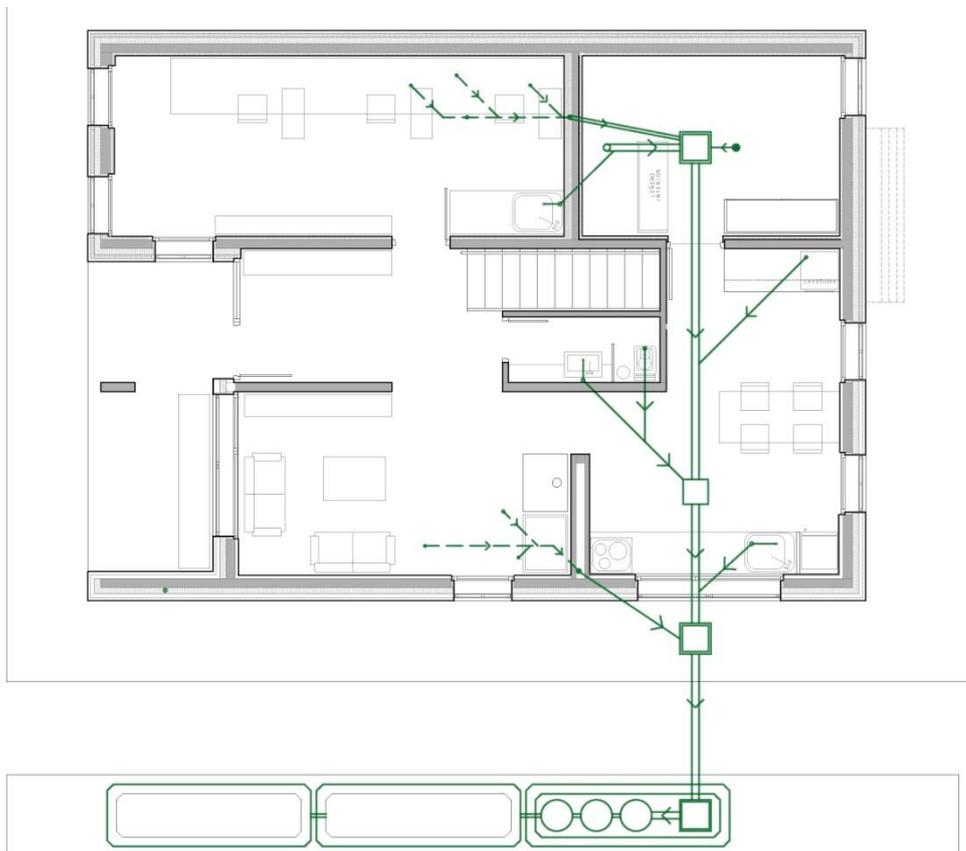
Planta baja. Sistema de saneamiento de las aguas grises
